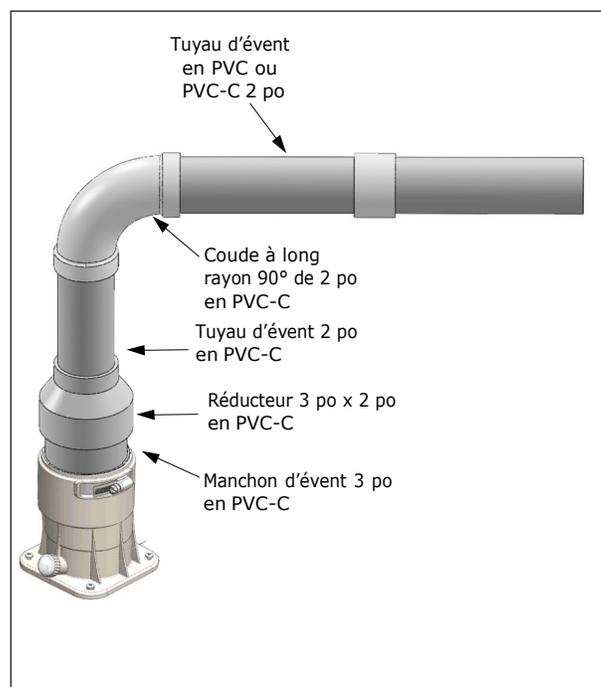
Installation horizontale, système d'évent en PVC/PVC-C de 2 po (60 mm)
